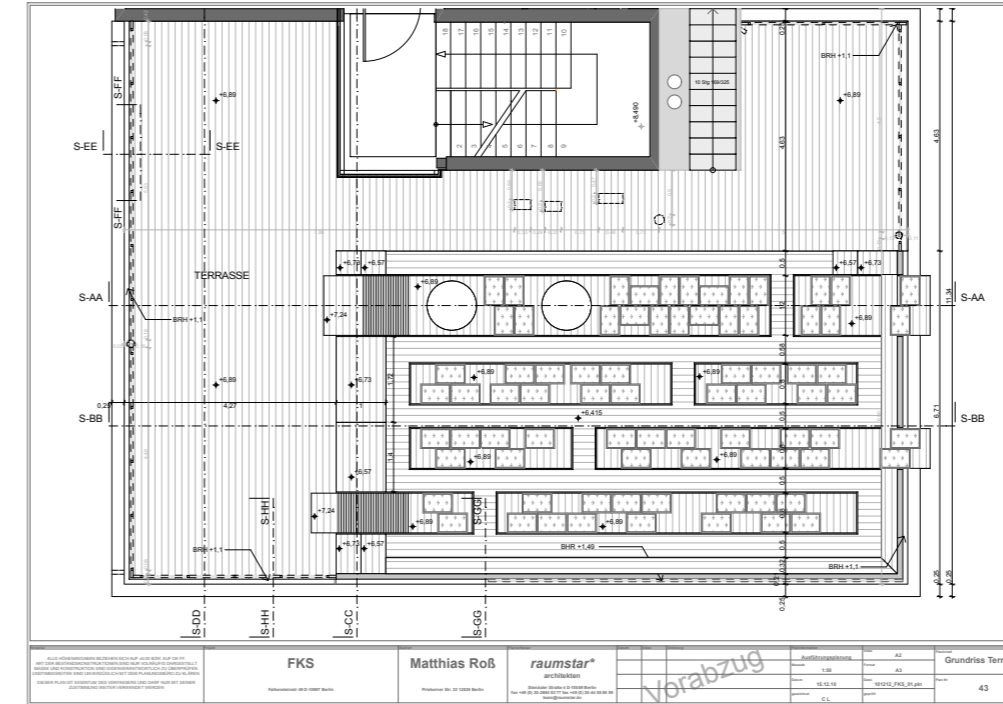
Dachgarten, Grundriss © RaumstarArchitekten
